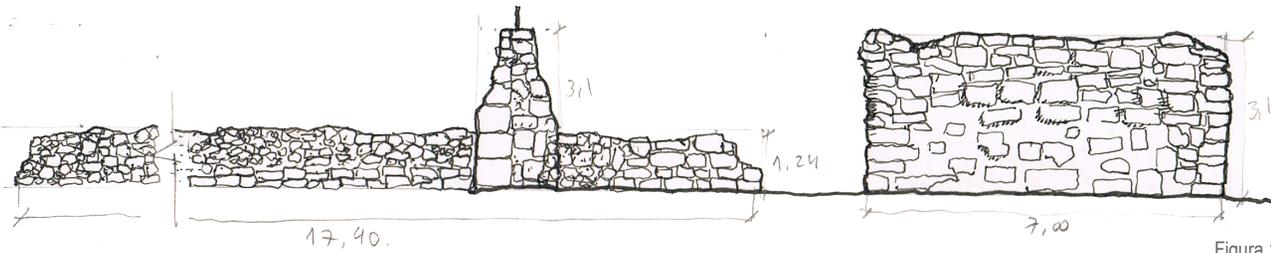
Levantamiento preliminar de la Mina Constanza.
